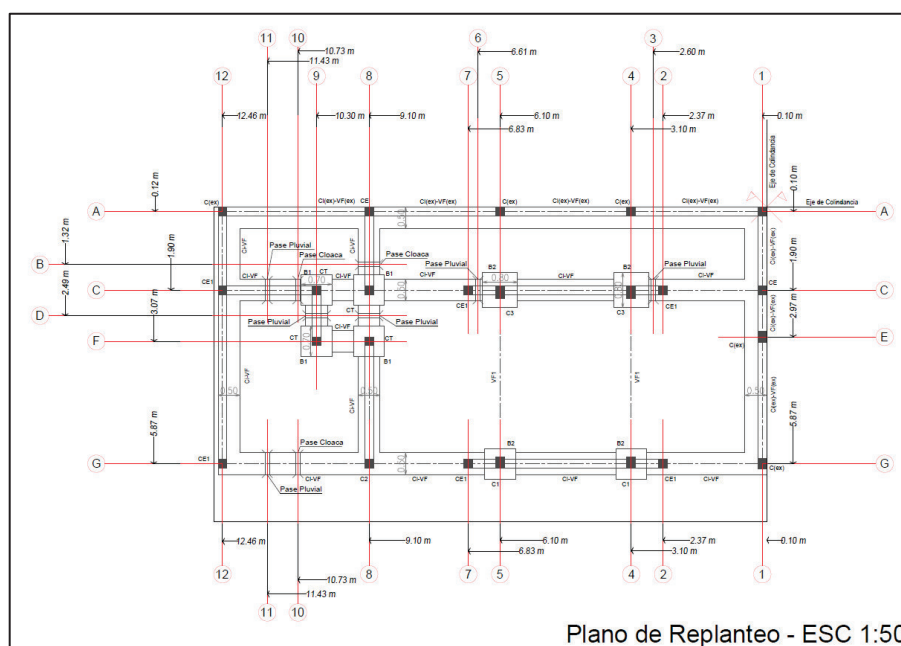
Primer plano de replanteo elaborado para el Salón Productivo.
